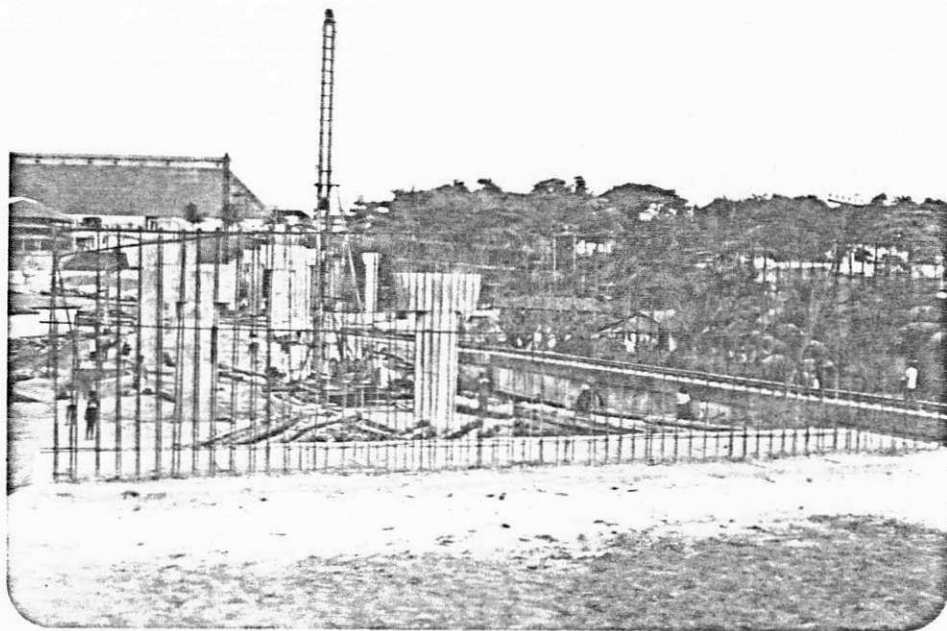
Panorâmica do local onde dar-se-á o encontro E₂ do viaduto, isto é, o encontro do viaduto com a Avenida Nova Liberdade.
